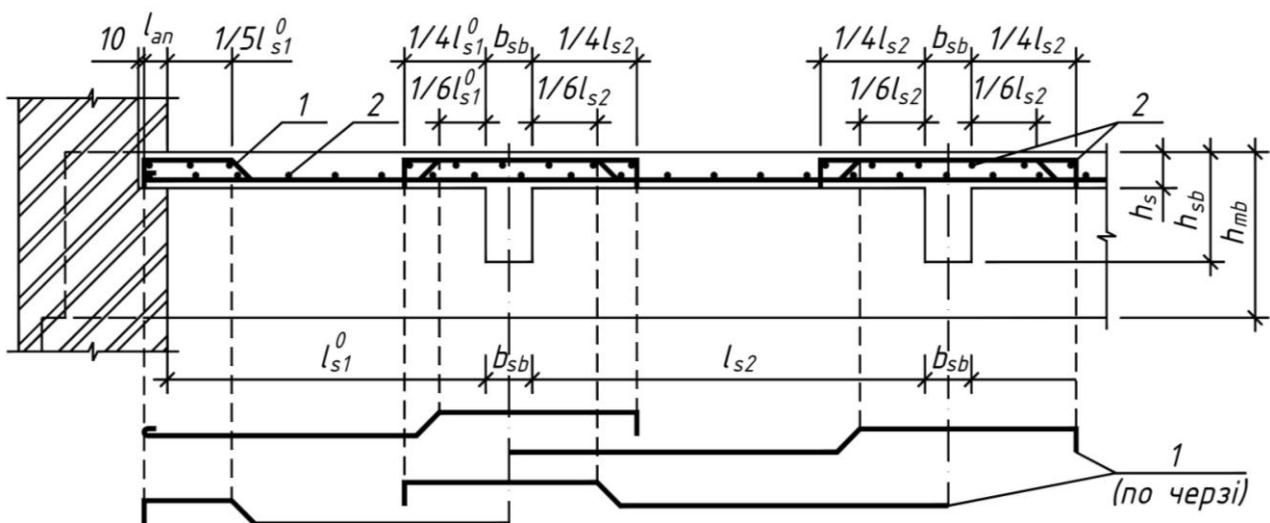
Безперервне армування плити окремими стержнями при $h_s > 80$ мм: 1 – робоча відігнута арматура; 2 – розподільна арматура
